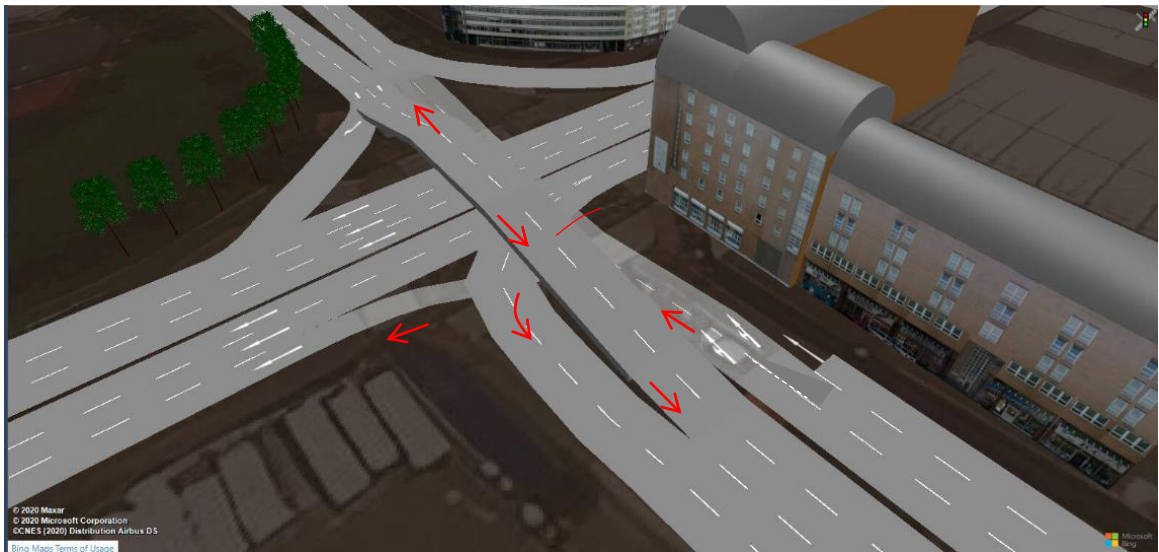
Detalle de maniobras alternativa 3, tomado de elaboración propia, (2021)
